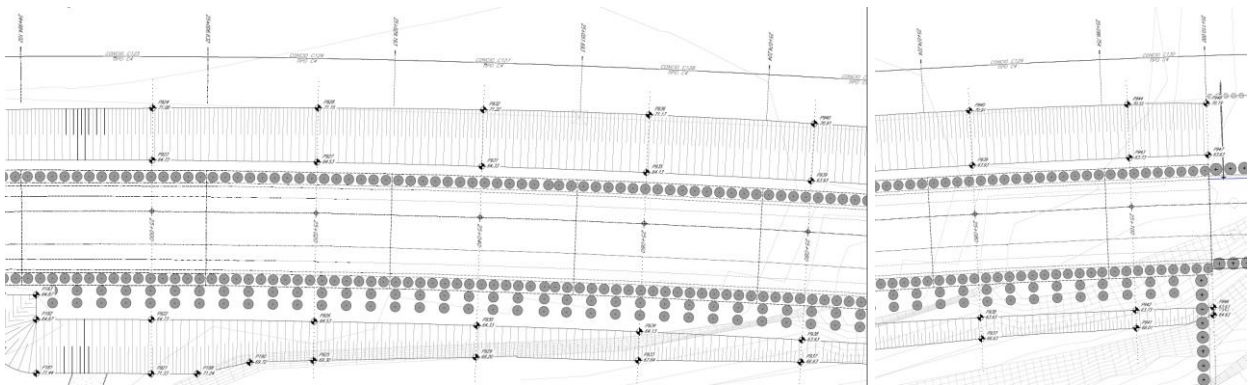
Stralcio della pianta scavi e delle sezioni dell'imbocco Nord (Rif. [VIII] e Rif. [IX])
